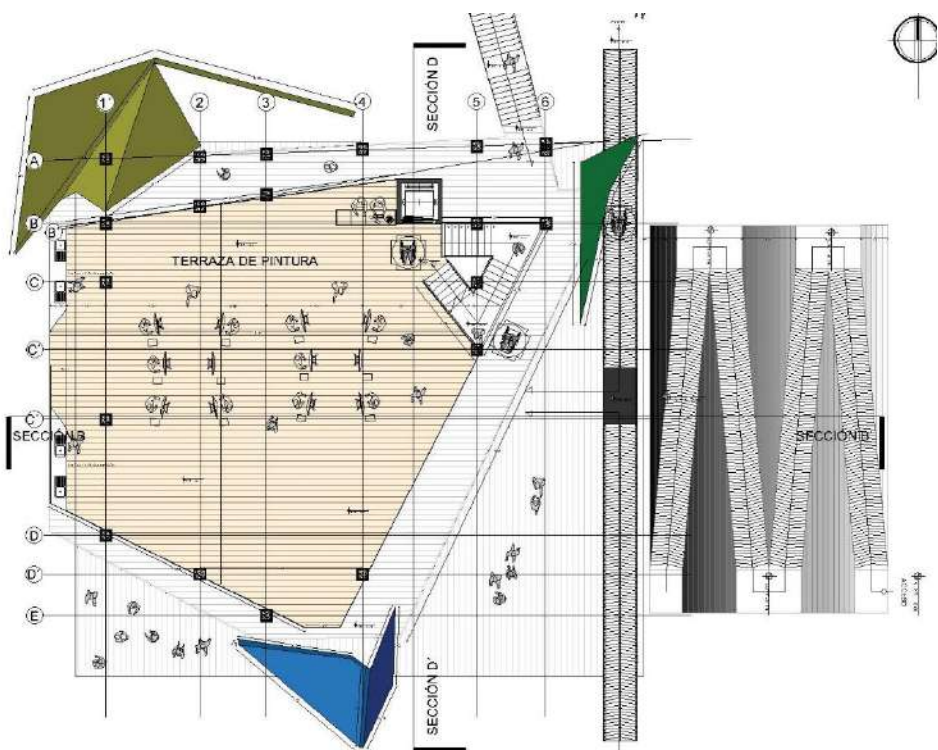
Planimetría edificio lúdico nivel +6.00. Fuente: Elaboración propia 2021.
